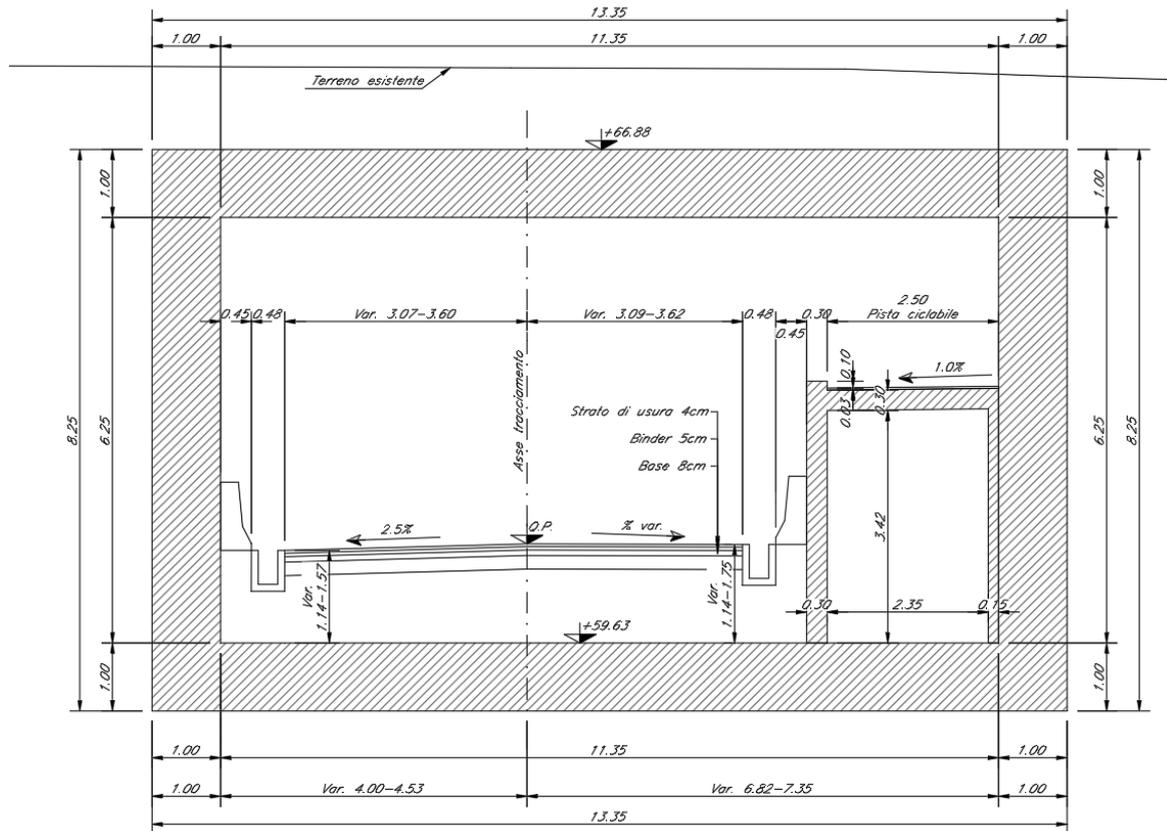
Sottopasso SL02 - Sezione trasversale dello scatolare
